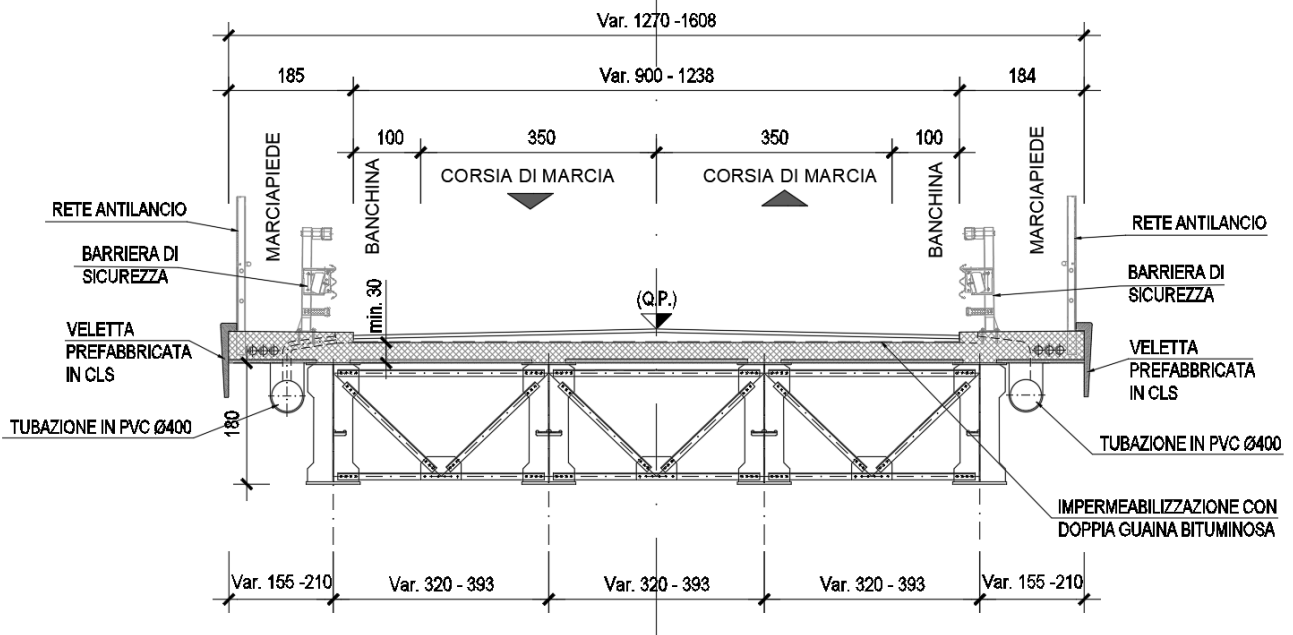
Sezione trasversale campata (travi H=1.80m)
